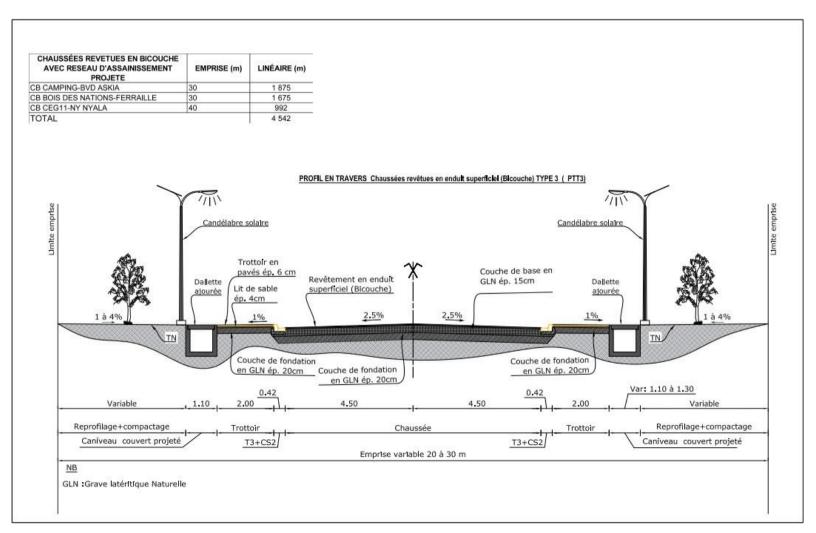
Profil en travers type 3 – Chaussée revêtue en enduit superficiel (PTT-3) Source : PIDUREM, Rapport APD, 2024
